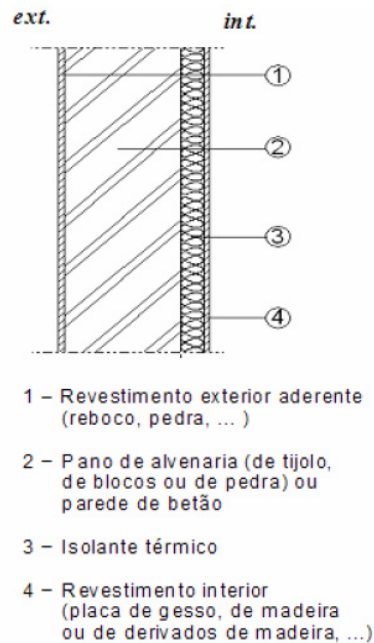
Isolamento pelo interior com o isolamento colado à face interior da parede exterior [25]
